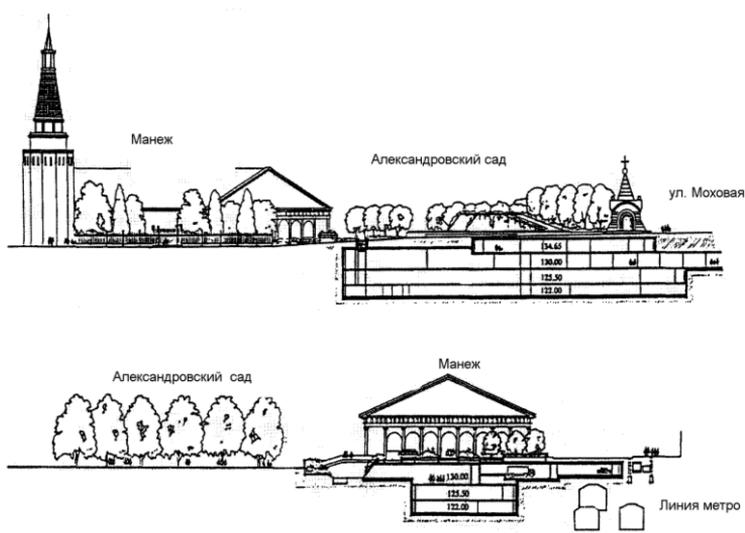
Реконструкция Манежной площади в г. Москве
